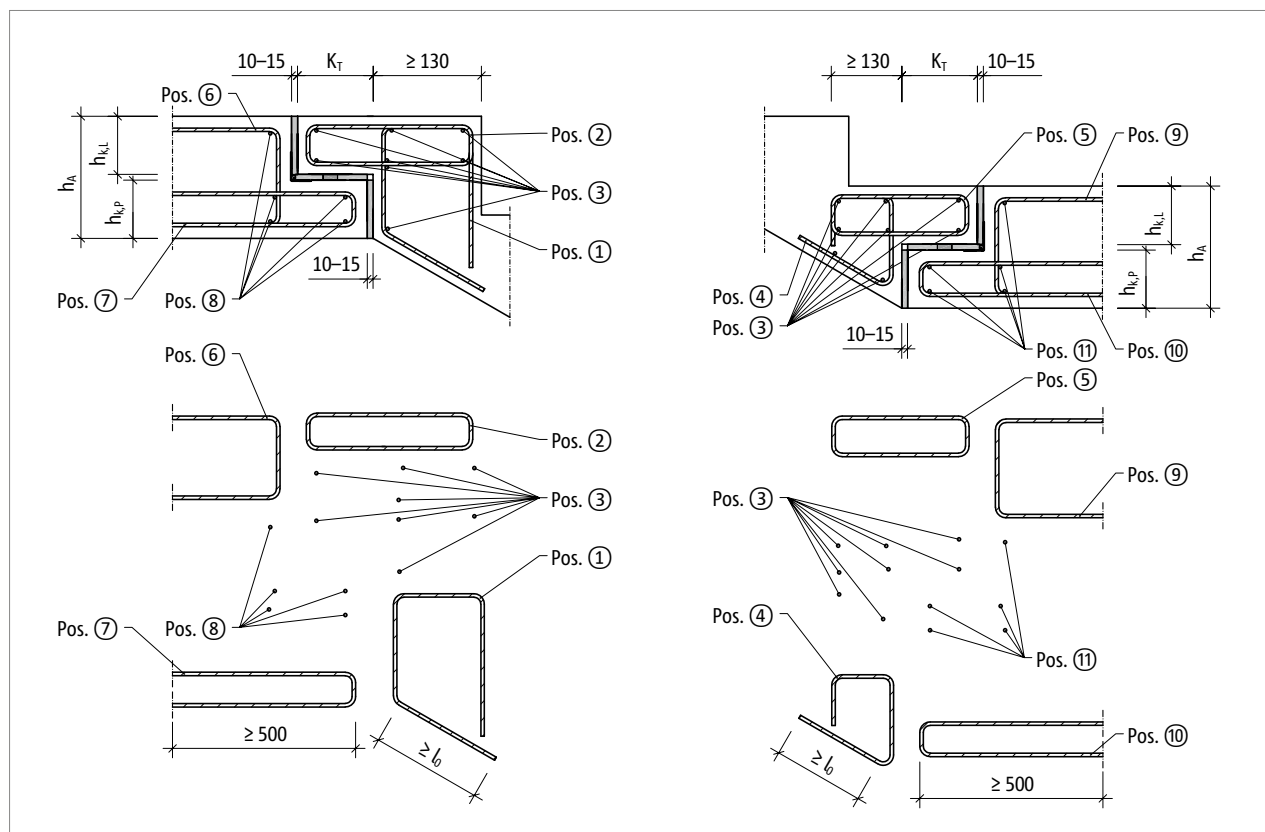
Tronsole® F: Bauseitige Bewehrung bei bündigem Anschluss
